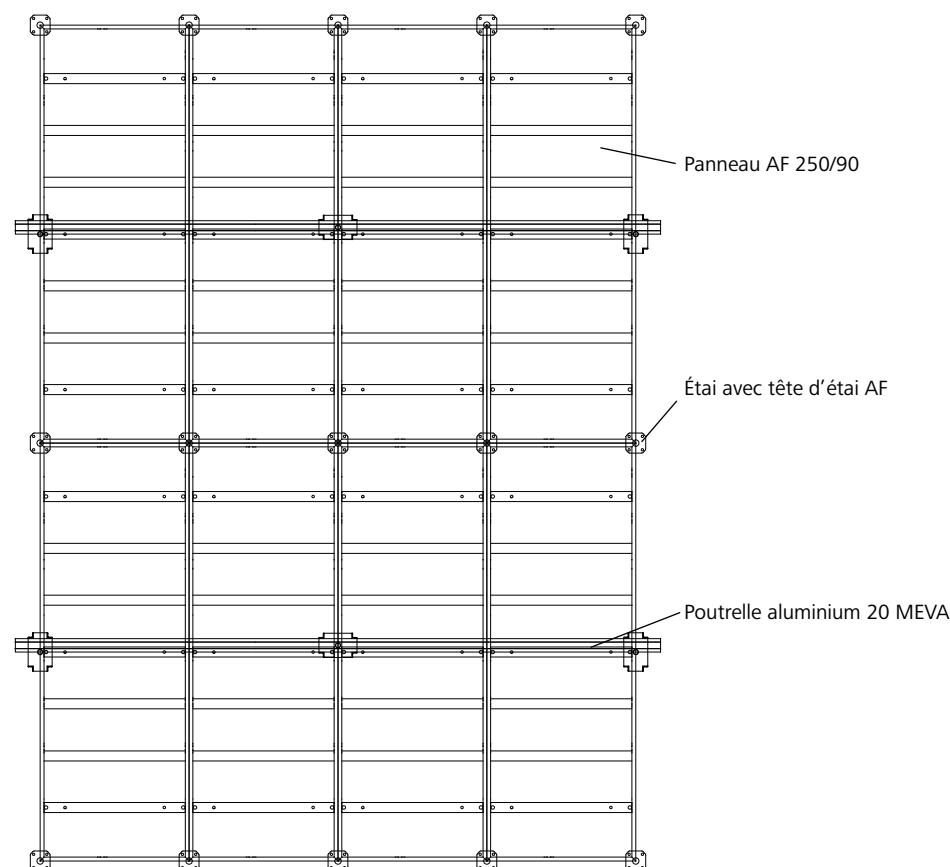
Poutrelle aluminium 20 MEVA utilisée comme poutre à deux travées
